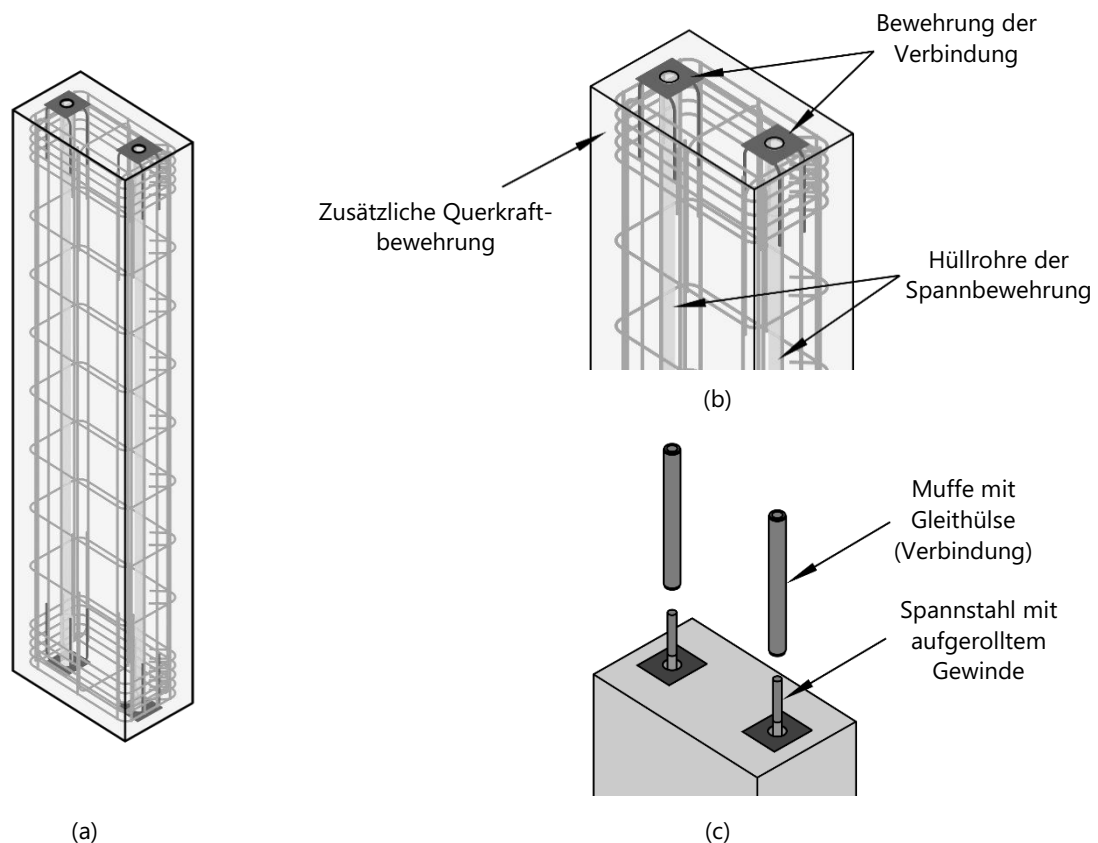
(a) Vereinfachtes Tragelement mit Schnittstellen und Bewehrungsführung, (b) Detail: Schnittstelle, (c) Explosionszeichnung: Spannstäbe und Muffenkopplung
